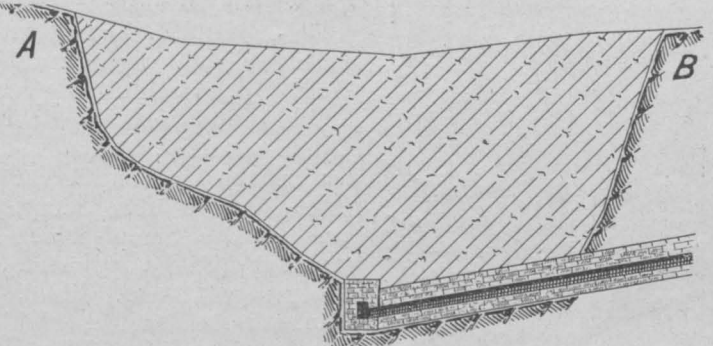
Querschnitt des Abzugskanales der Entwässerungstollen an der Sohle des zugeschütteten tiefen Grabens. Maßstab 1:400.
